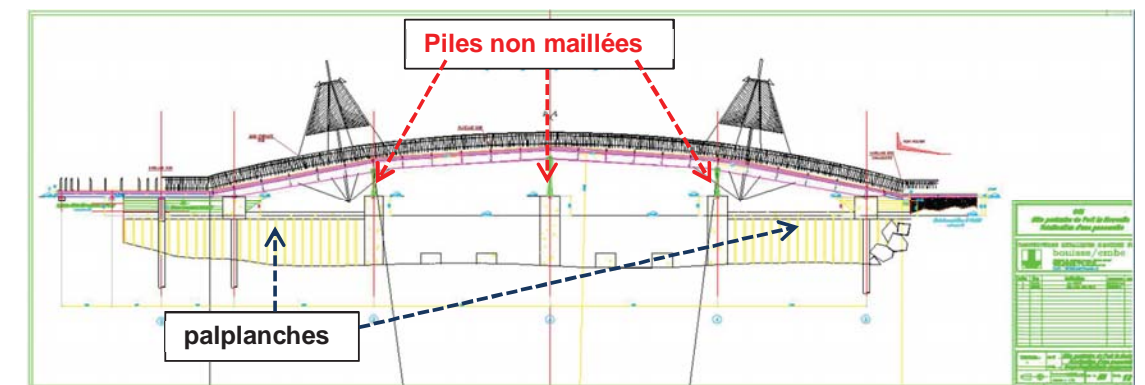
Plan AUTOCAD de l'actuelle passerelle – anciennement barrage à vannes
